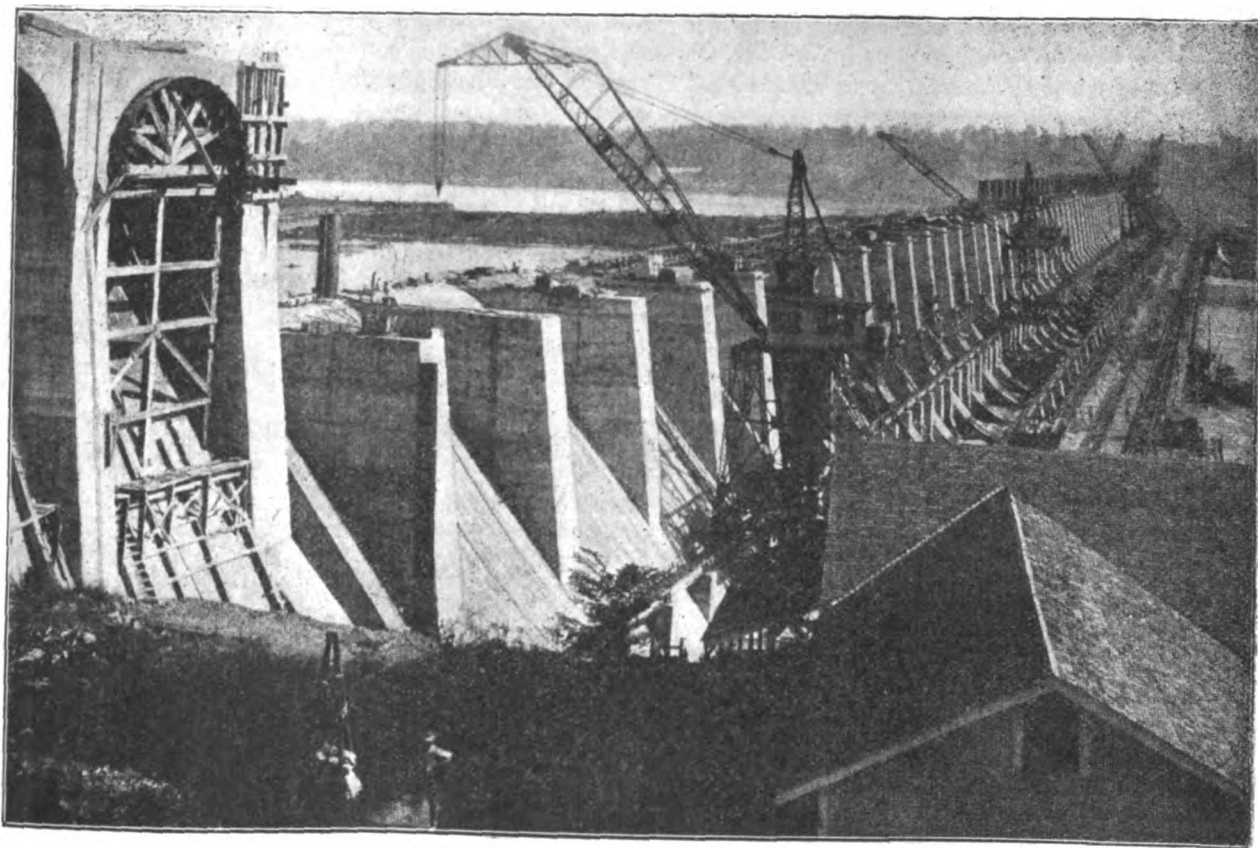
Vue photographique prise pendant la construction du barrage n° 2.
